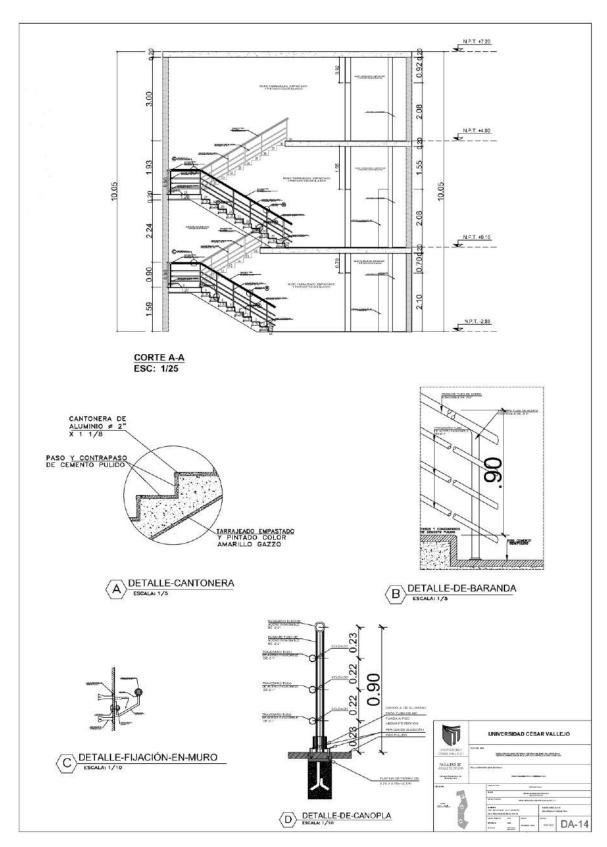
Detalle de escalera de emergencia - DETALLES ARQUITECTÓNICOS
